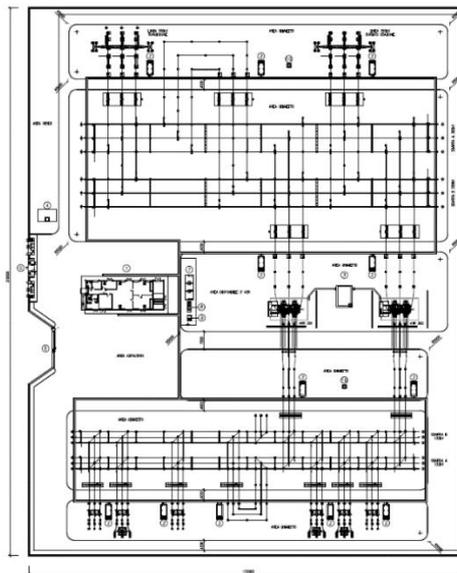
Planimetria Stazione Elettrica 380/132 kV
